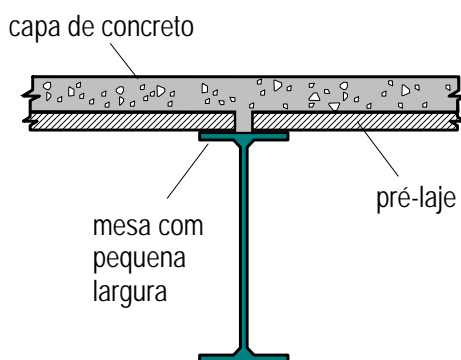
Sistema de piso misto com pré-laje de concreto.
